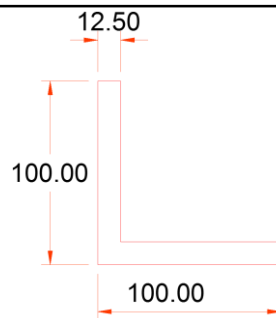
Dimensiones de perfil metálico L4x4x1/2 (en mm).
